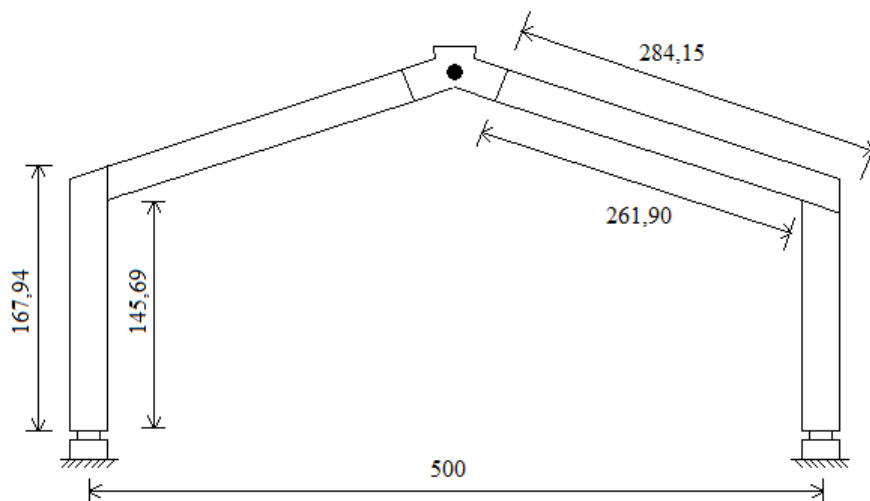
Configuração geométrica da estrutura executada, dimensões em cm.
